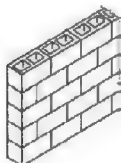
混凝土空心小砌块墙体的立面组砌形式
